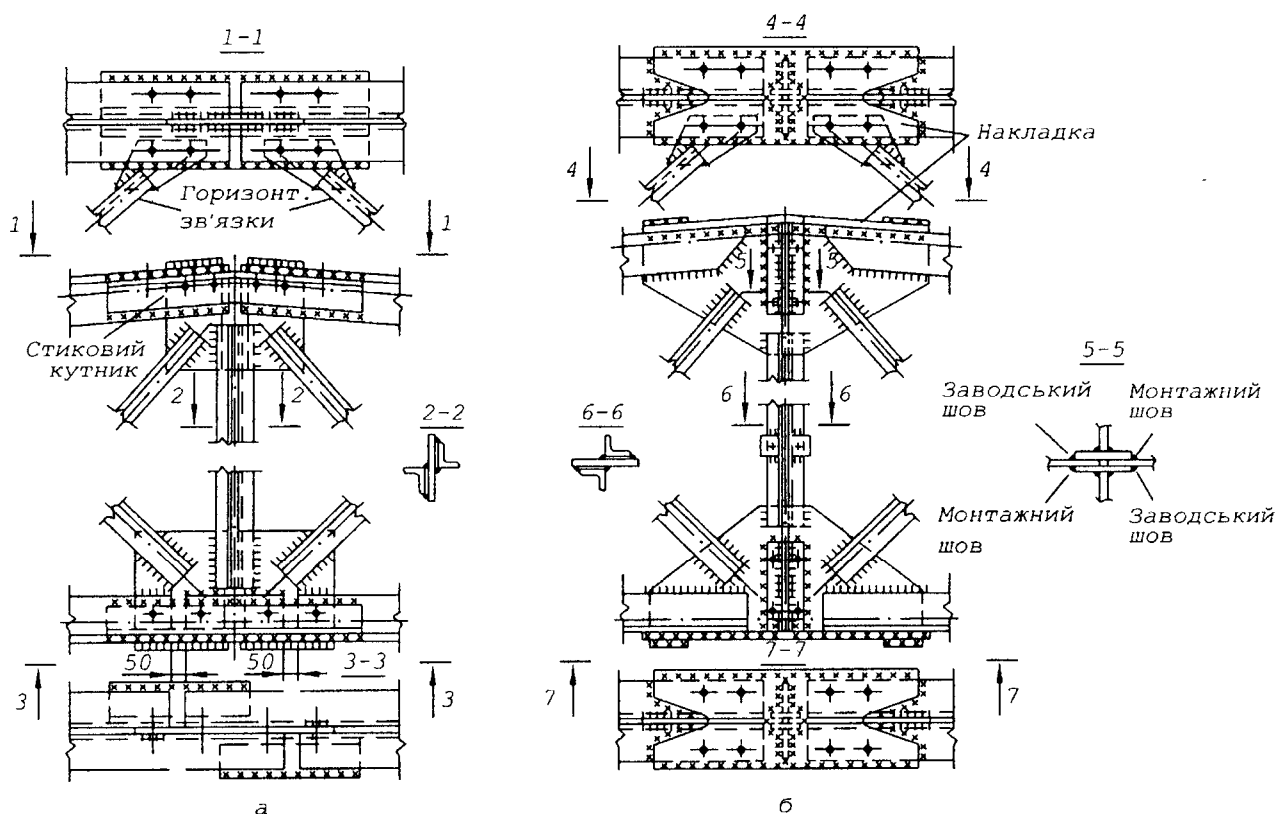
Монтажні стики верхнього та нижнього поясів ферм:
